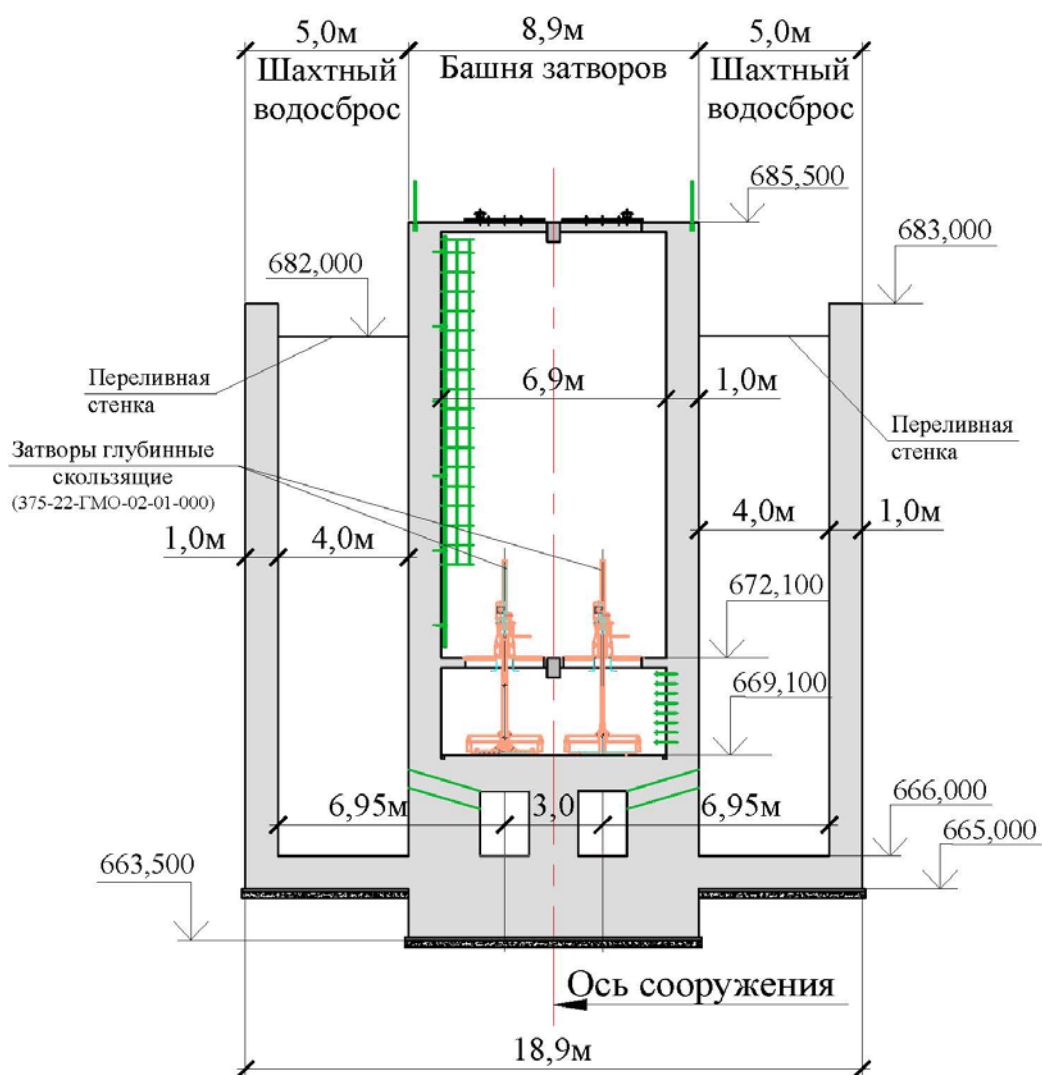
Поперечный разрез по башне затворов с шахтным водосбросом
